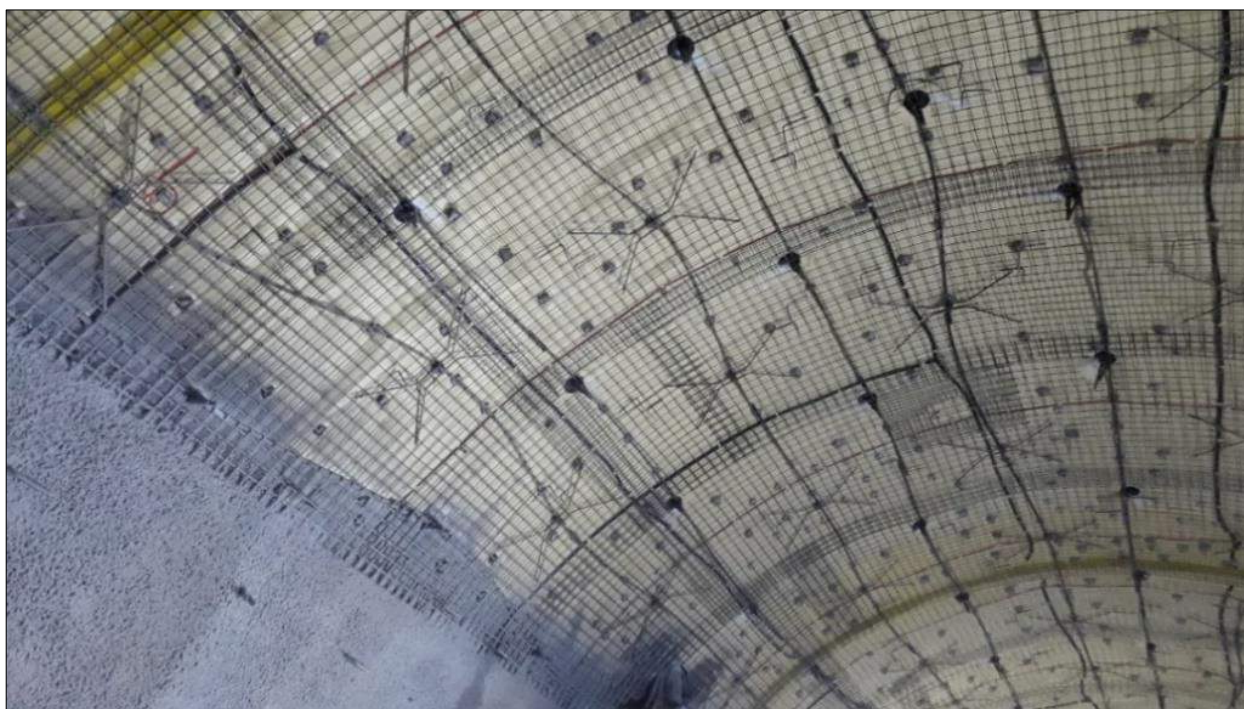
Fixação de telas metálicas aos *trumpets*, auxiliada por aranhas e pastilhas de concreto
